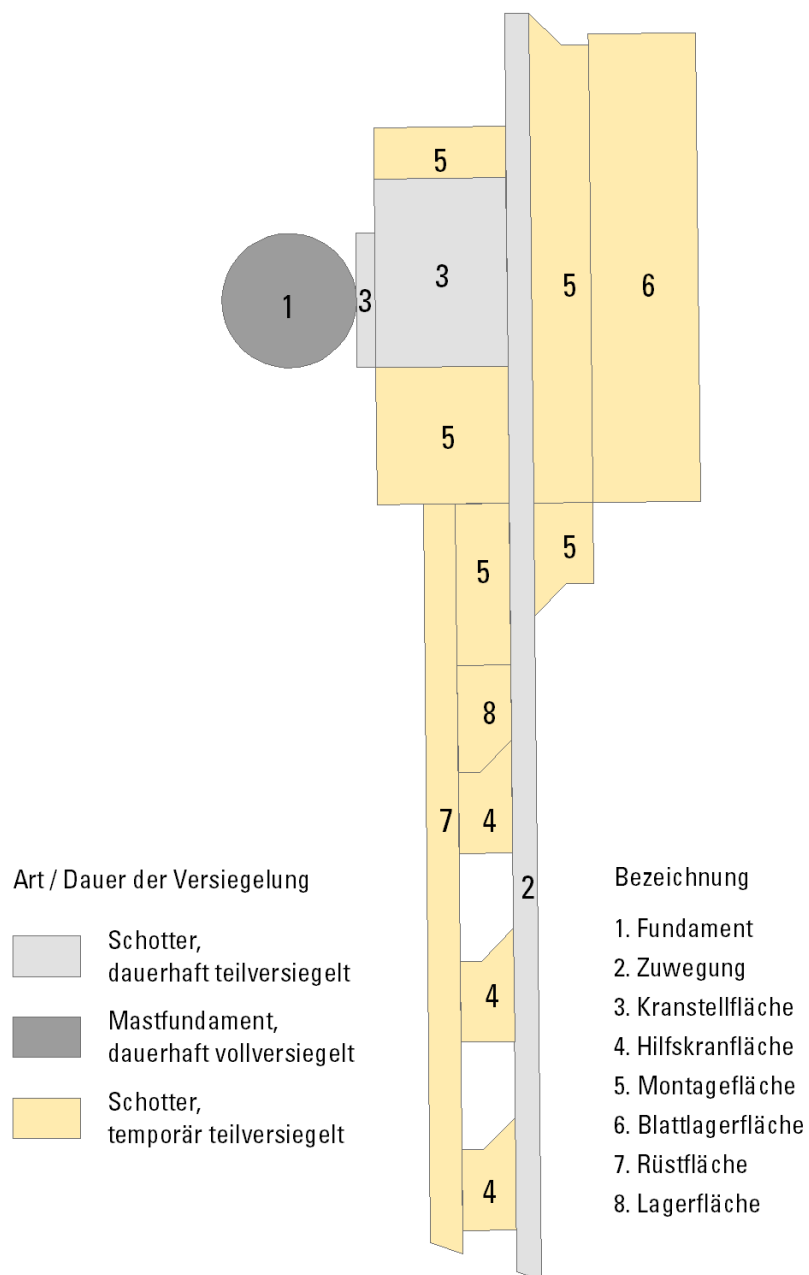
Beispielhafter Lageplan einer WEA mit dauerhaft und temporär beanspruchten Flächen
